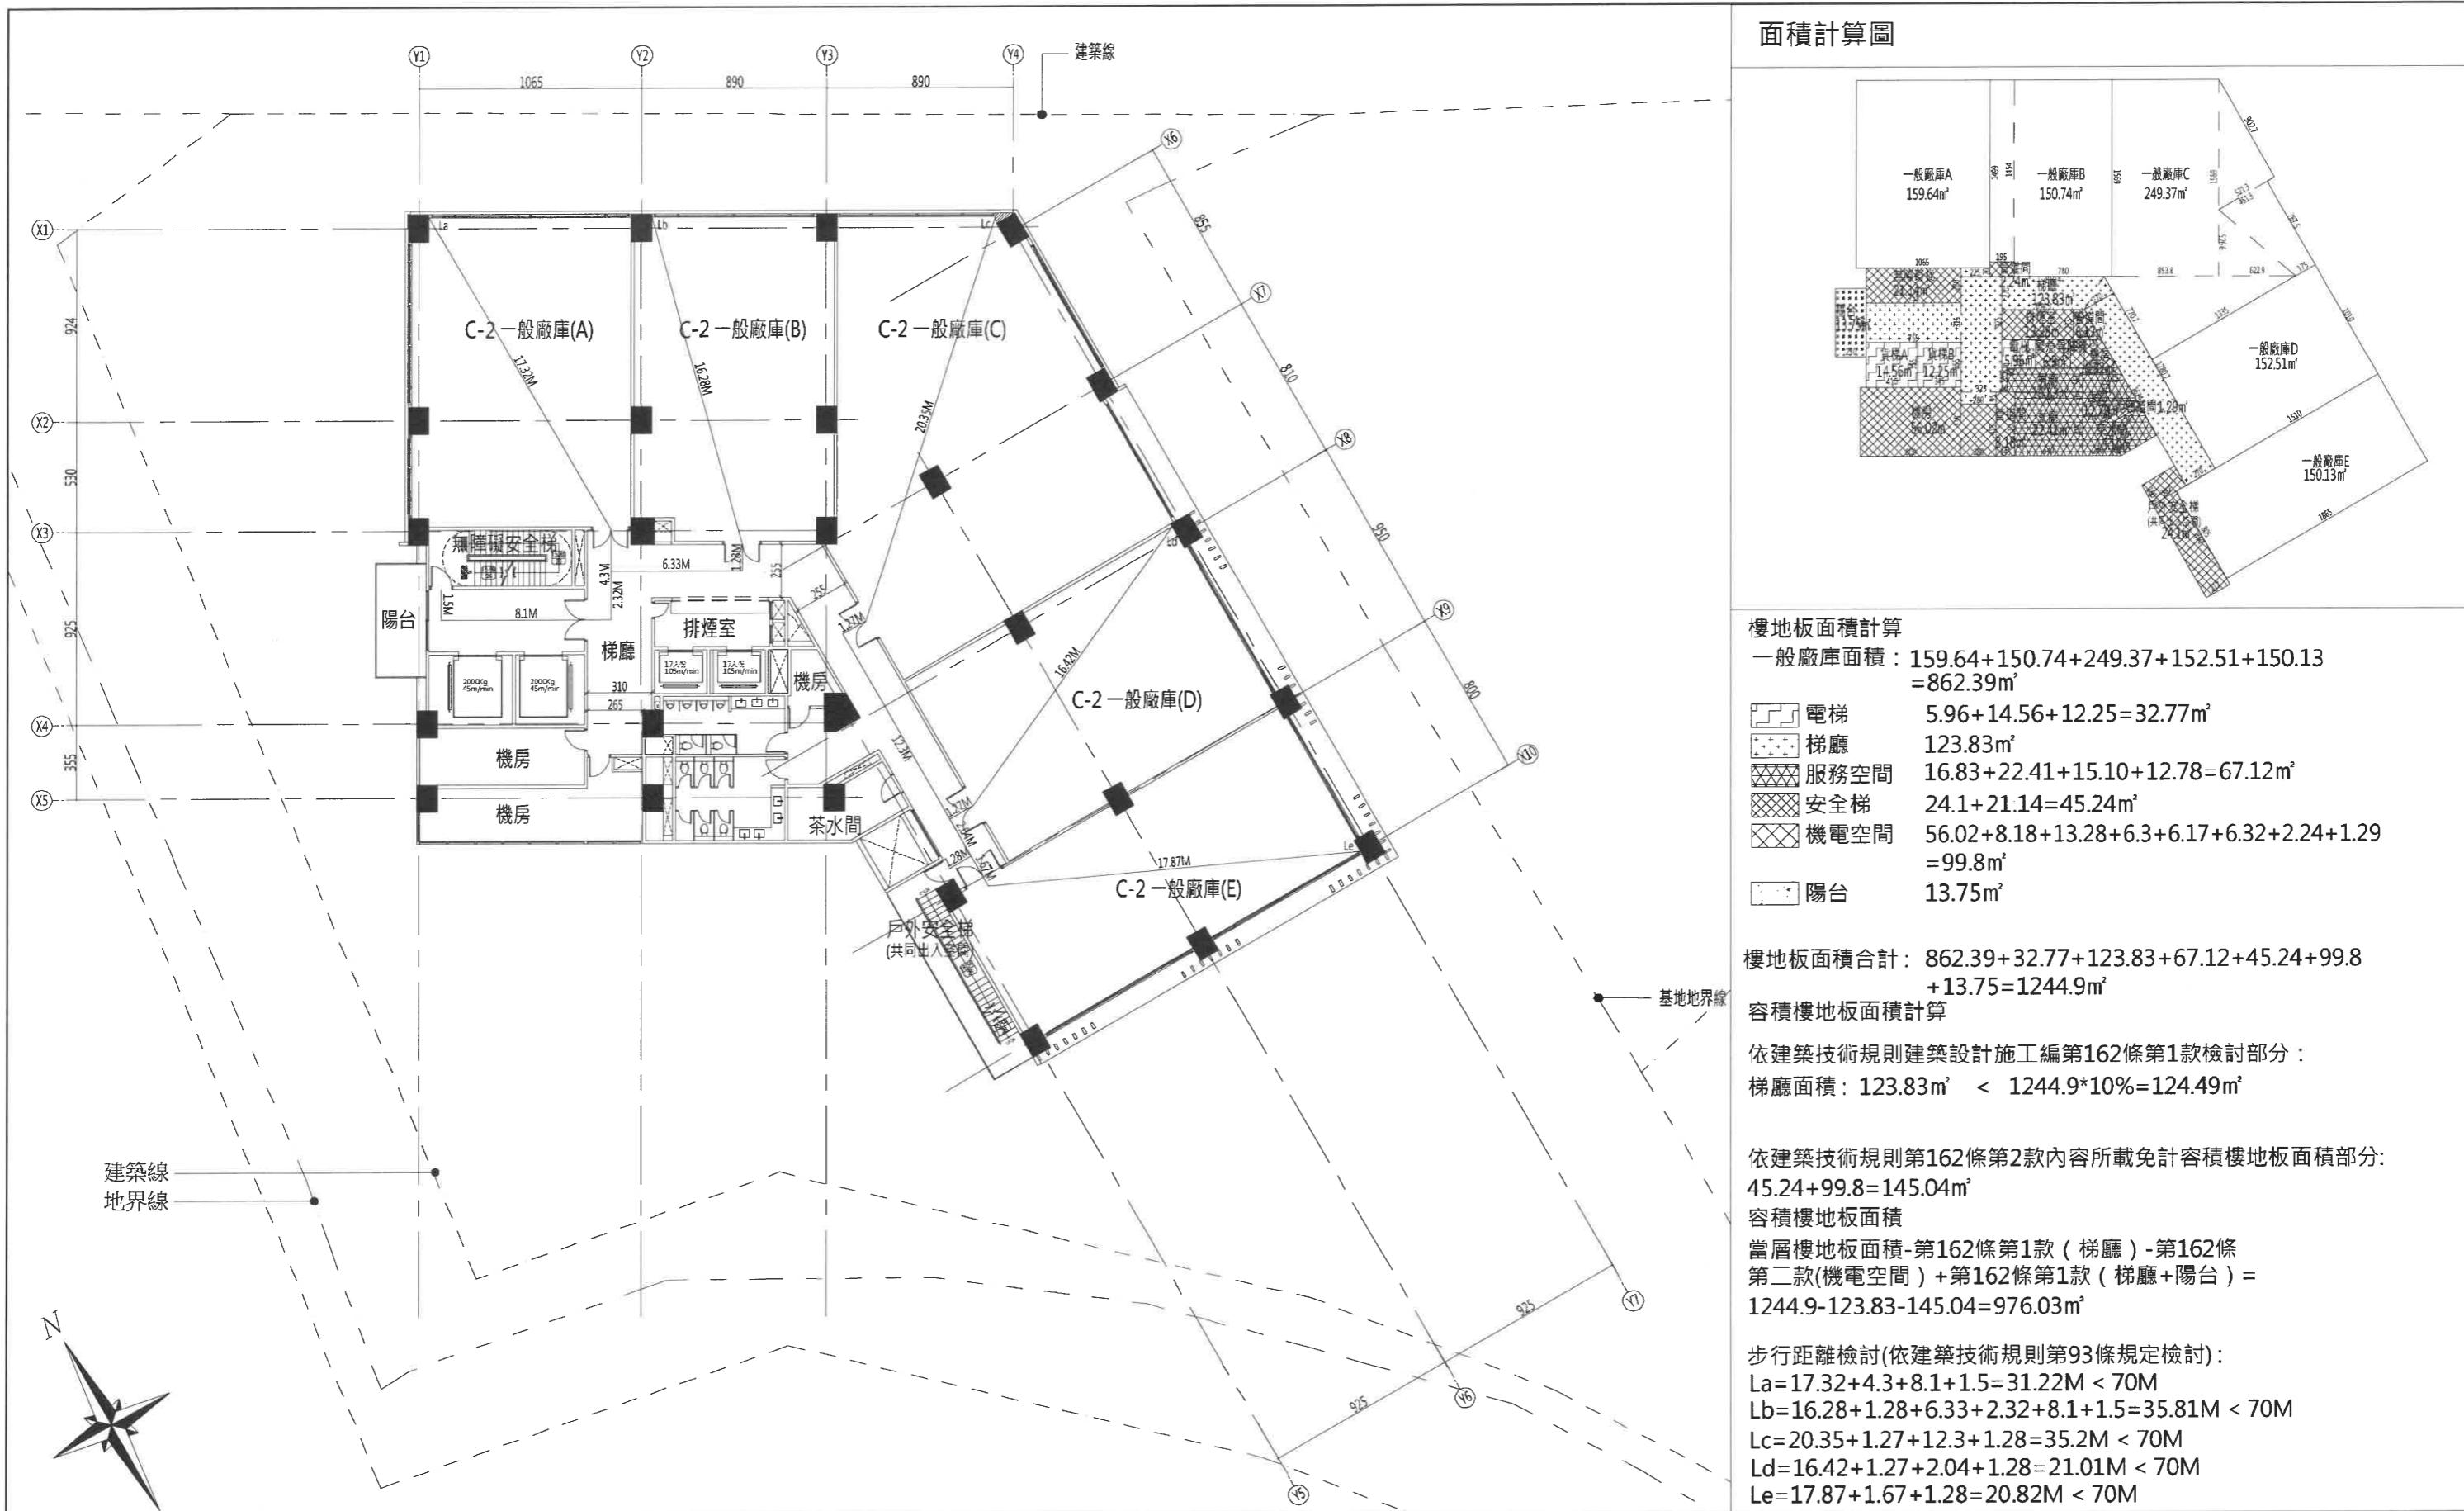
地上五層平面圖(維持原核定)(S : 1/300)
